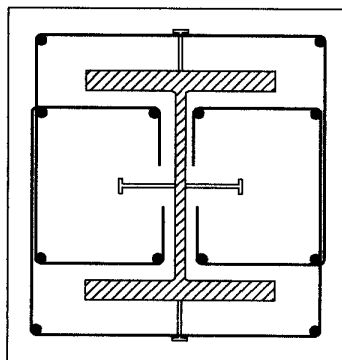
Detalles de columnas de sección mixta de acero-concreto.
